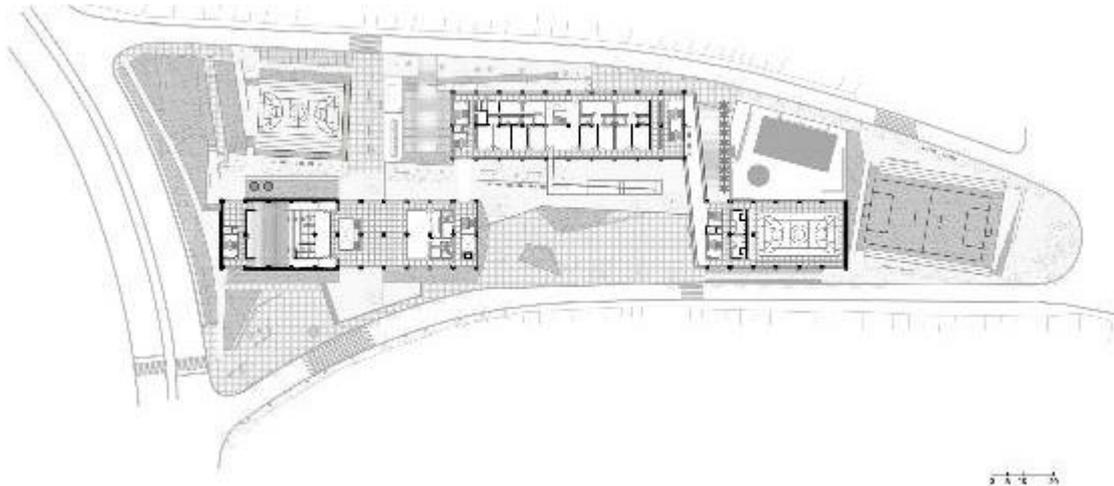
Planta geral - segundo pavimento. Fonte: SIAA + Helena Ayoub Silva & Arquitetos Associados, 2020.
